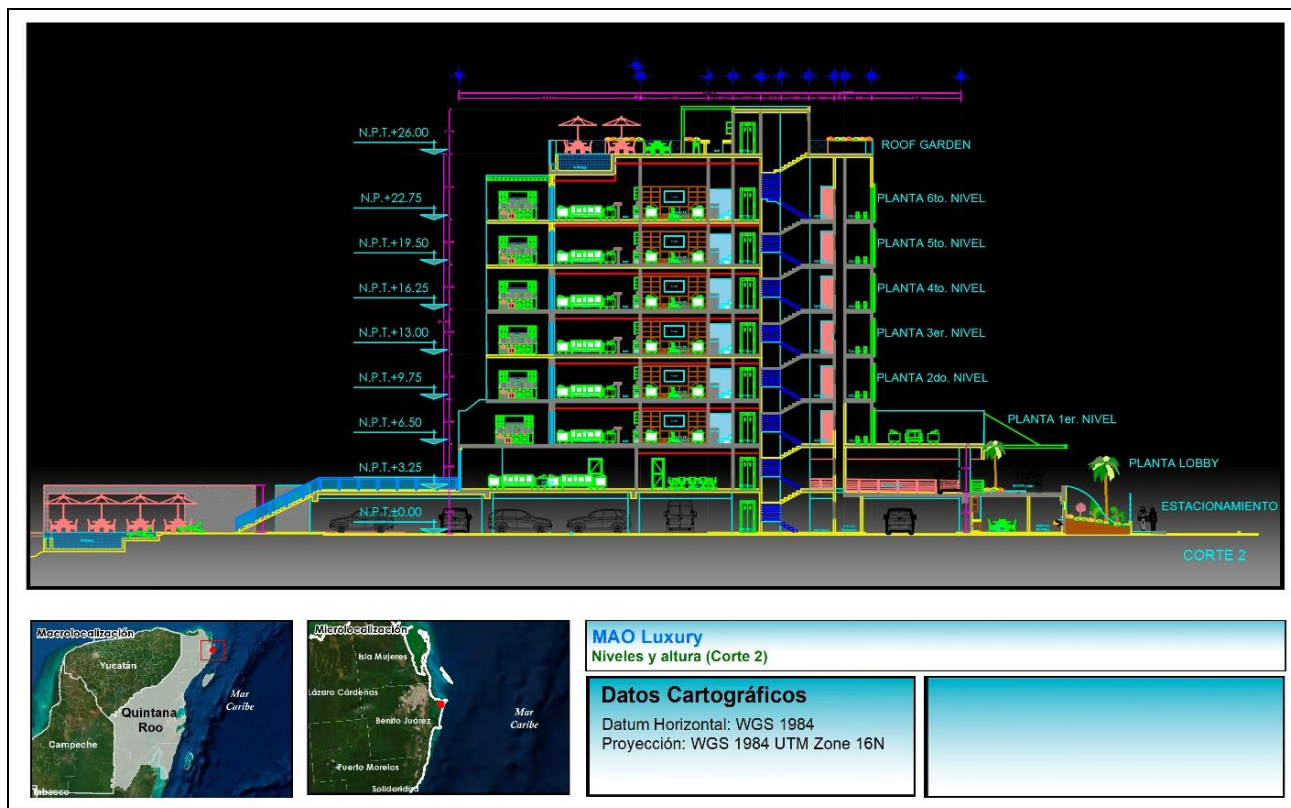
Corte lateral de la fachada de la torre condominal a construir en el Lote 26 del Paseo Pok Ta Pok mostrando sus niveles y altura.
